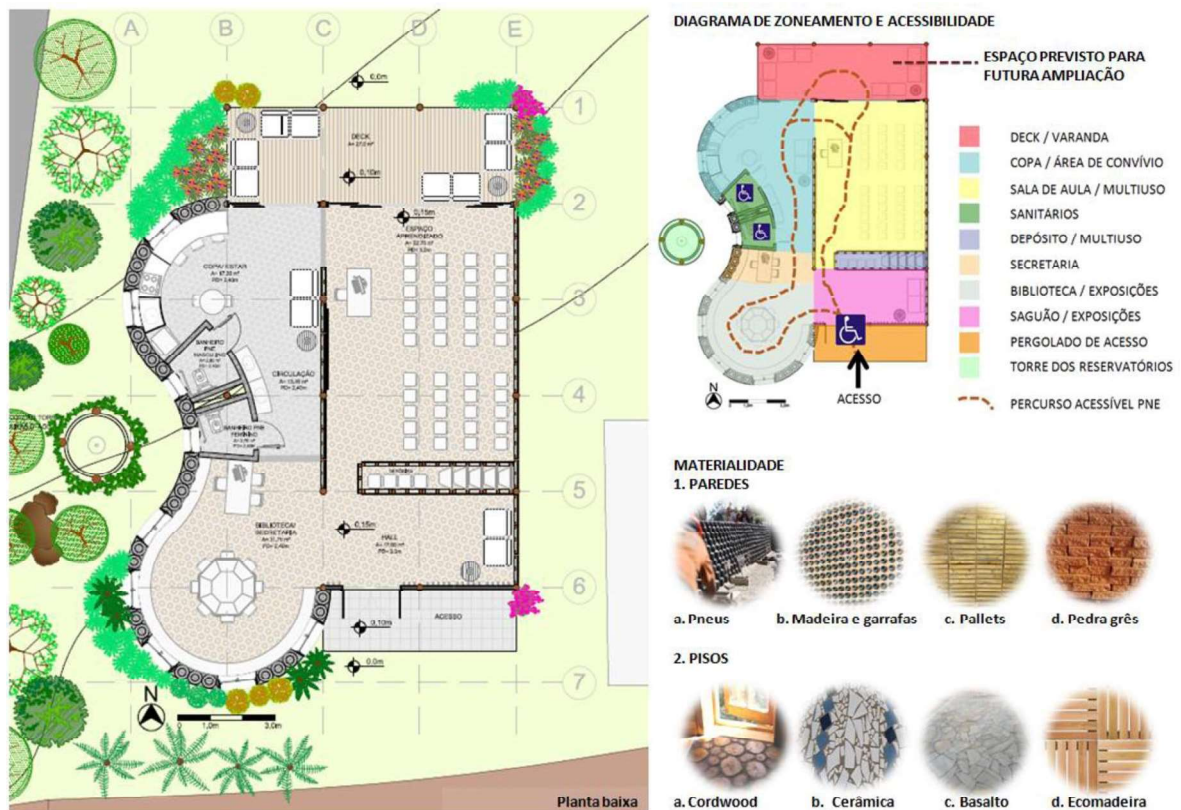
Planta baixa, diagrama de zoneamento e de acessibilidade.
